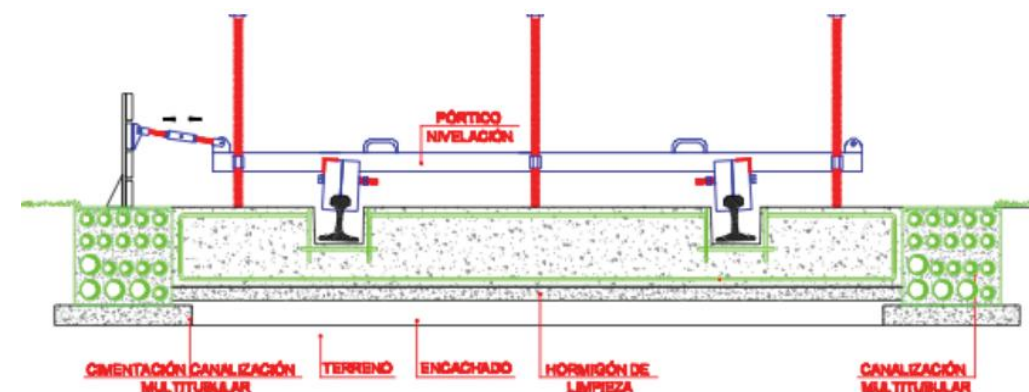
Posicionamiento del carril mediante pórticos. Fuente: Adaptado de SENER
